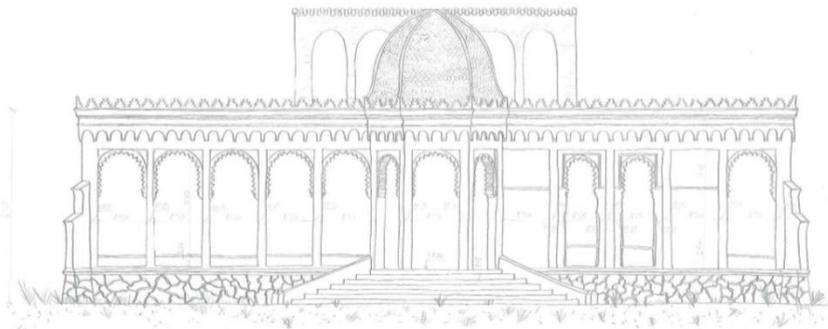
Croquis Alzado Oeste (2014) - Fuente propia
